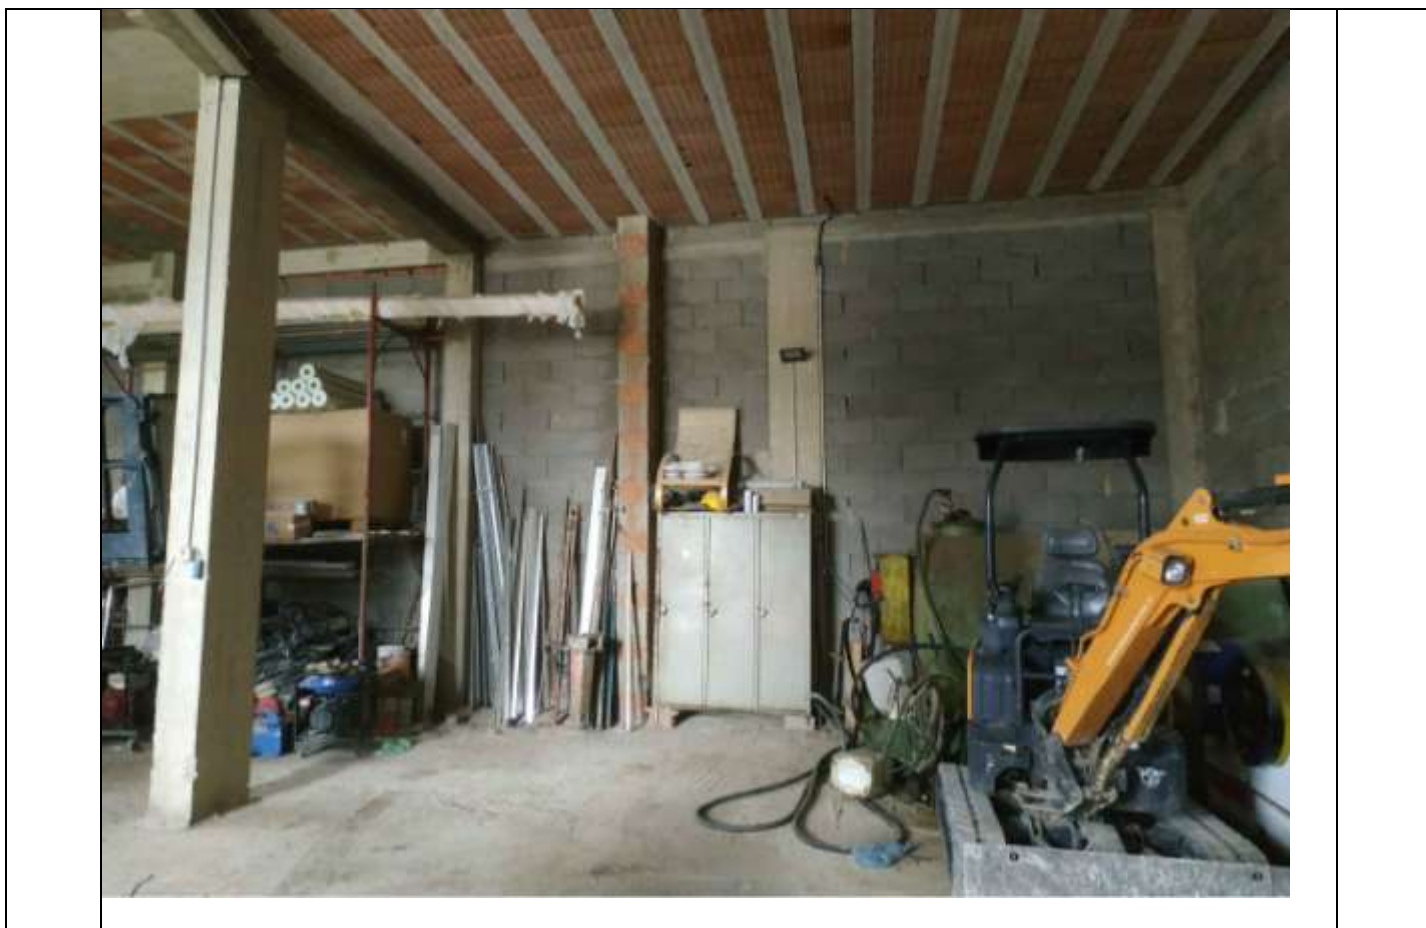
Foto 3: Vista interna Sub 6 - Particola del vano di collegamento col Sub 5 - Lotto 6
